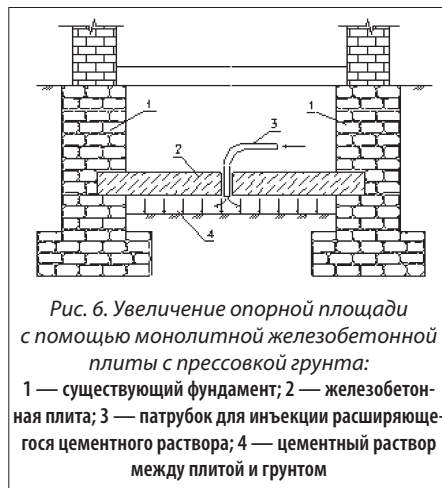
Увеличение опорной площади с помощью монолитной железобетонной плиты с прессовкой грунта:
